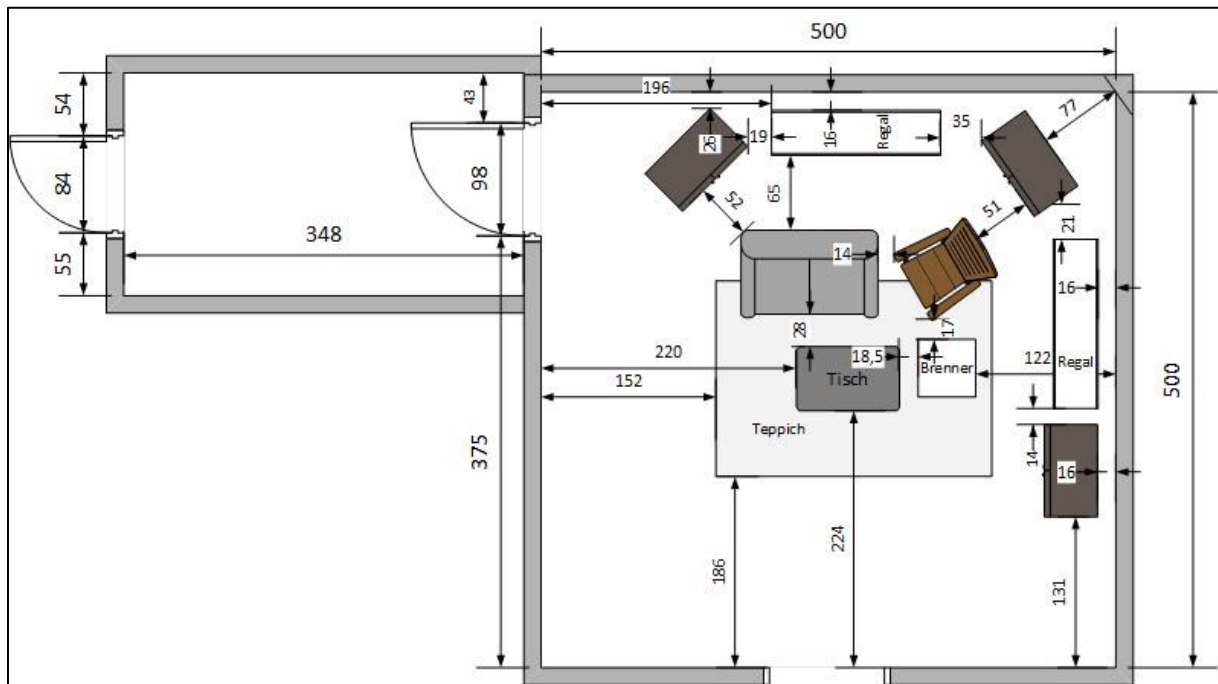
Grundriss Brandraum mit Möbeln (Eigene Darstellung 2019)
